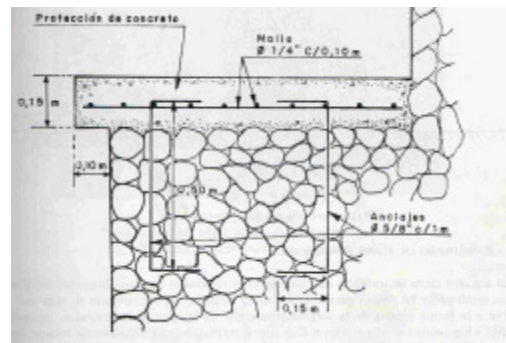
Detalle de protección de los escalones (Suárez, 1993)
